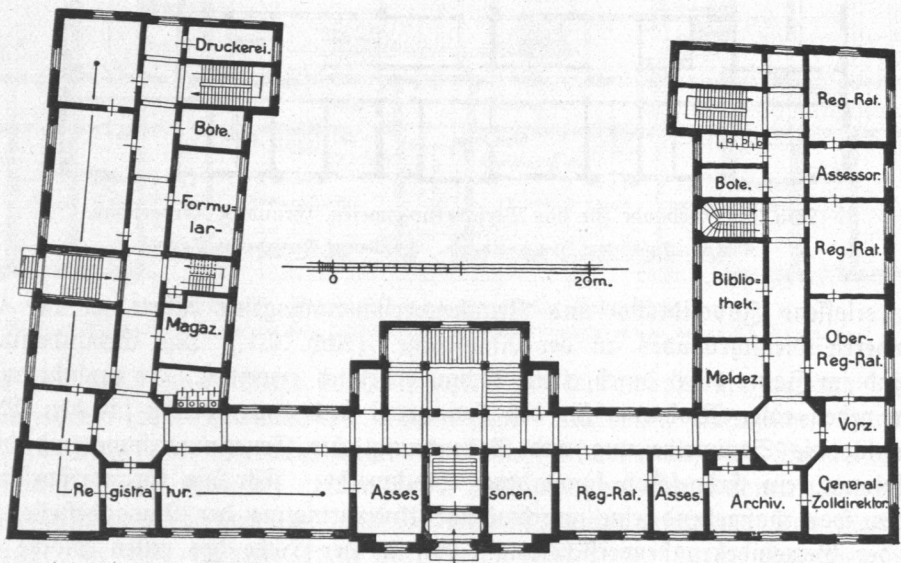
Generalzolldirektionsgebäude, Grundriß, Erdgeschoß.
